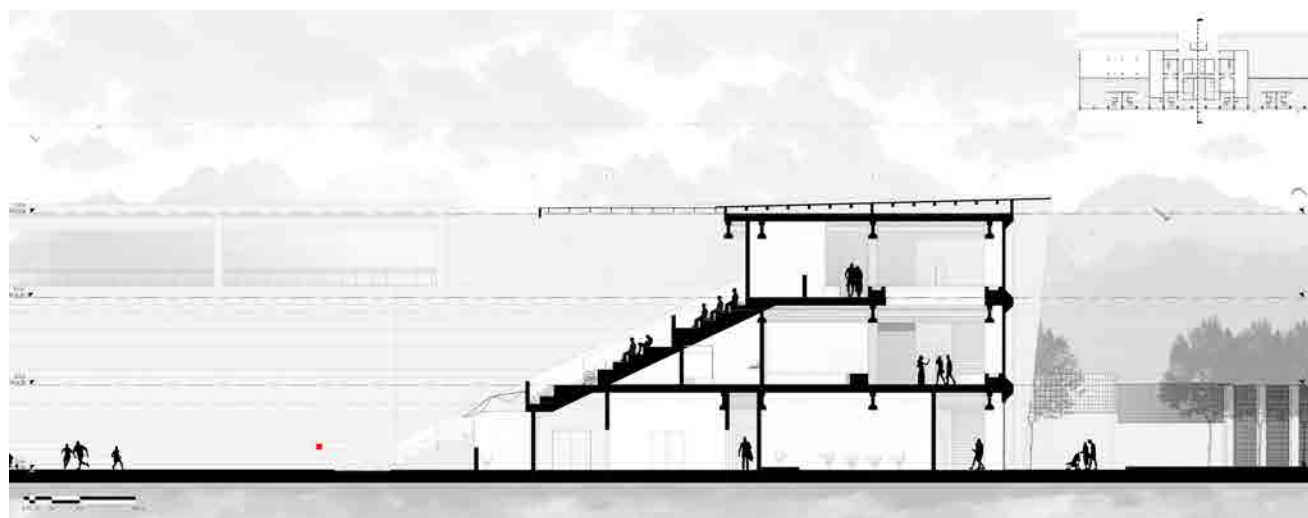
Sección transversal bloque derecho. Elaboración: Autores.
